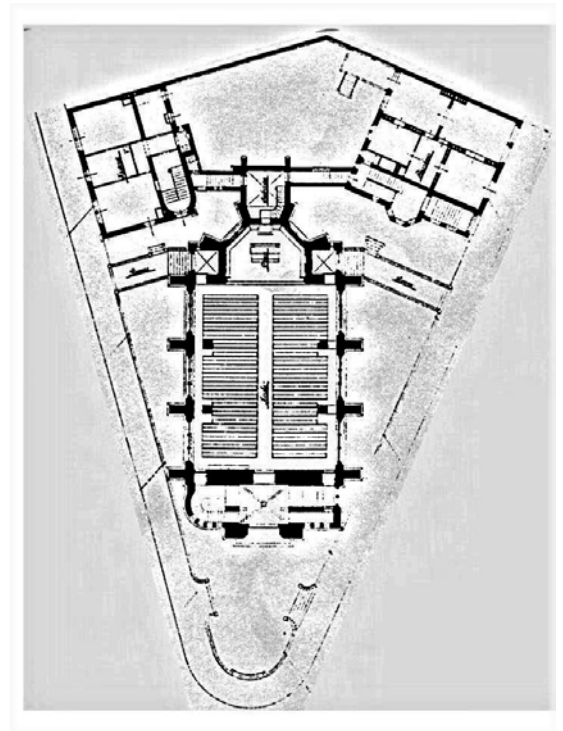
Grundriss und Situationsplan Gebäudegruppe
